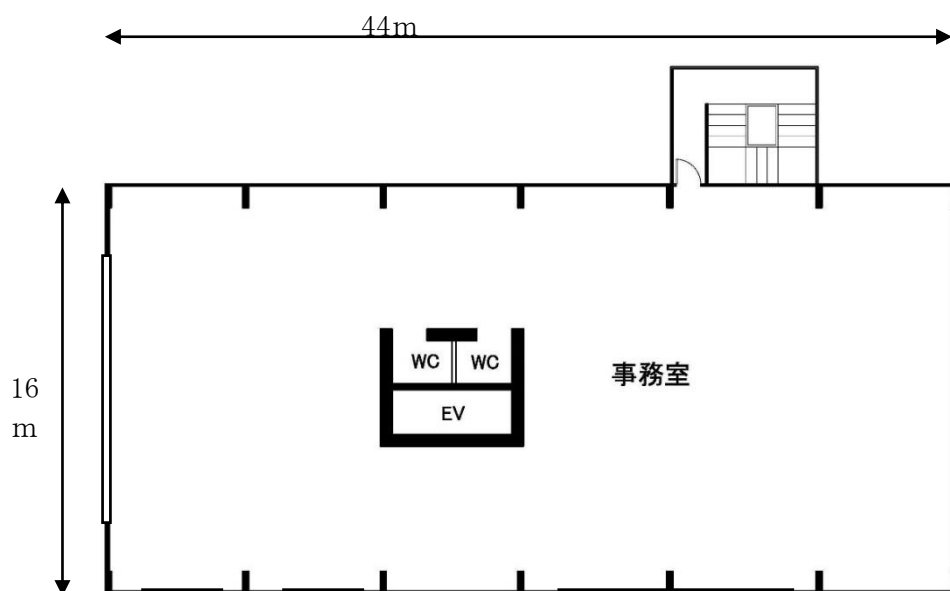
2-2 事務所建築 2（カナダ）分析対象事務所建築の基準階平面図
